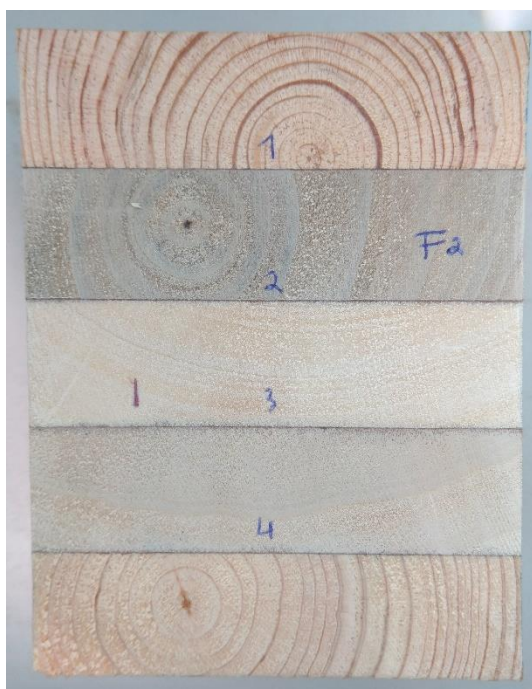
Perfil transversal da viga mista choupo-pinho, viga R6
